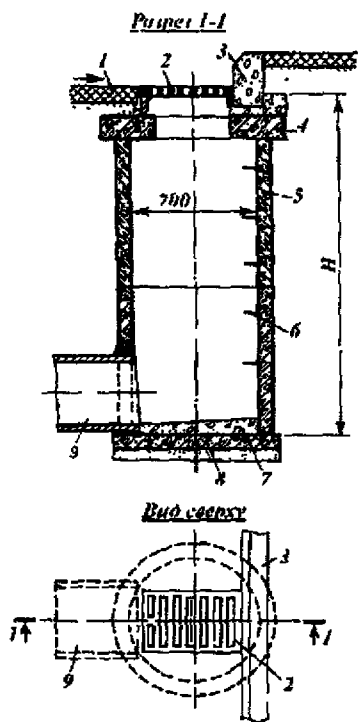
Дождеприемник из сборных железобетонных элементов: 1 – проезжая часть, покрытая асфальтом; 2 – решетка; 3 – бордюрный камень; 4 – плита перекрытия; 5 – кольца стеновые; 6 – ходовые скобы; 7 – бетон; 8 – плита днища; 9 – соединительная труба
